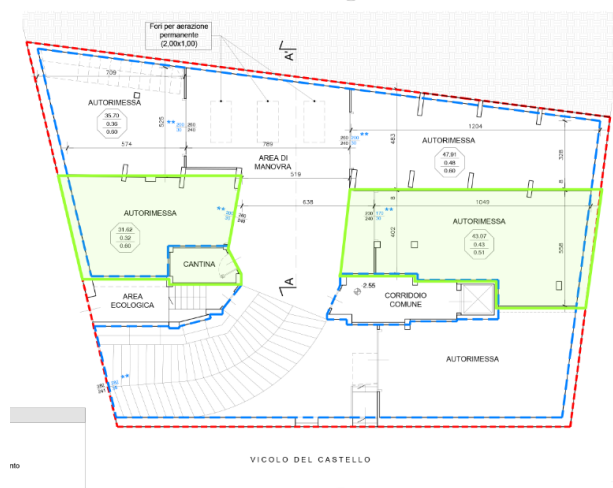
ESTRATTO PLANIMETRIA ALLEGATA ULTIMA SCIA DEL 2021 - INEFFICACE
